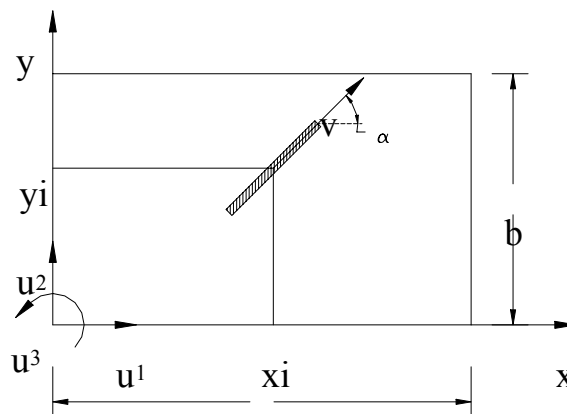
Planta del edificio y sistema de coordenadas utilizado
